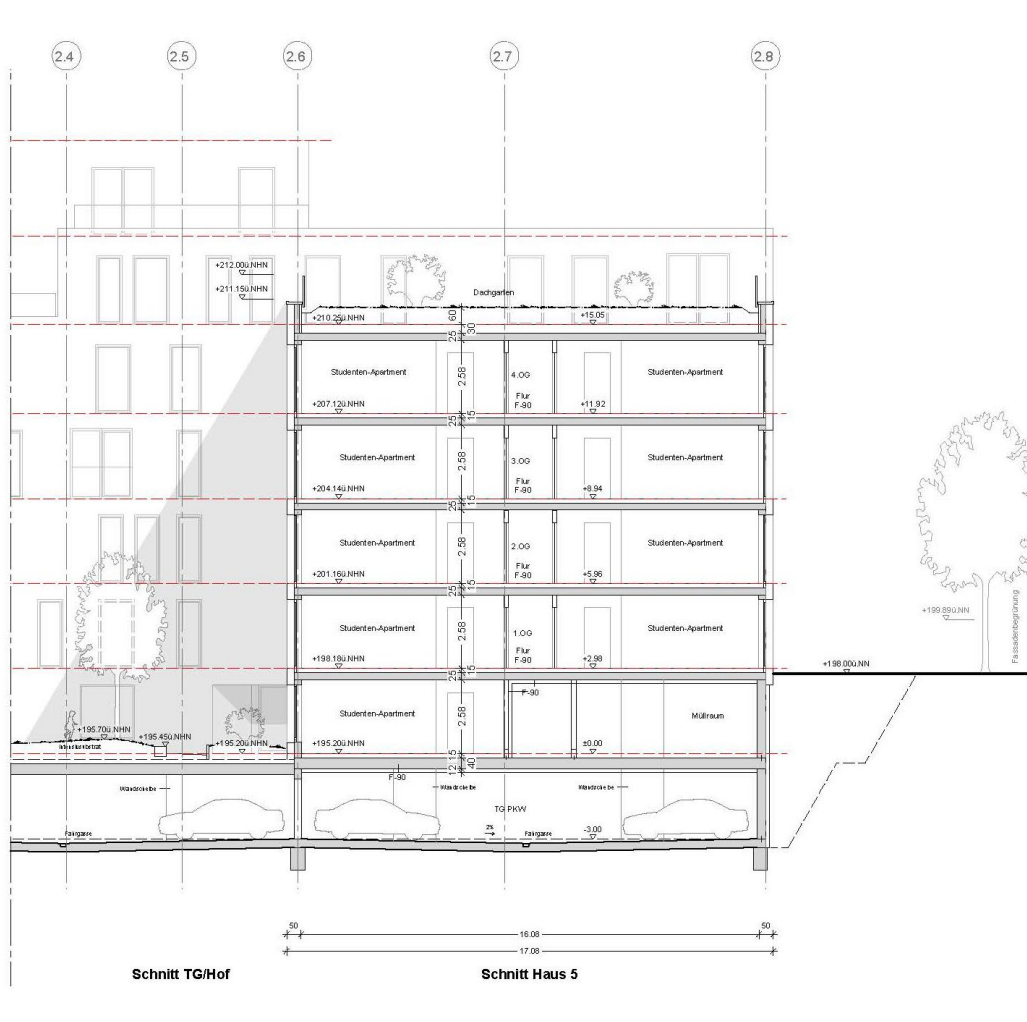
Geländeschnitt durch geplantes Haus 5 (vonhoegen. architekten gmbh)
